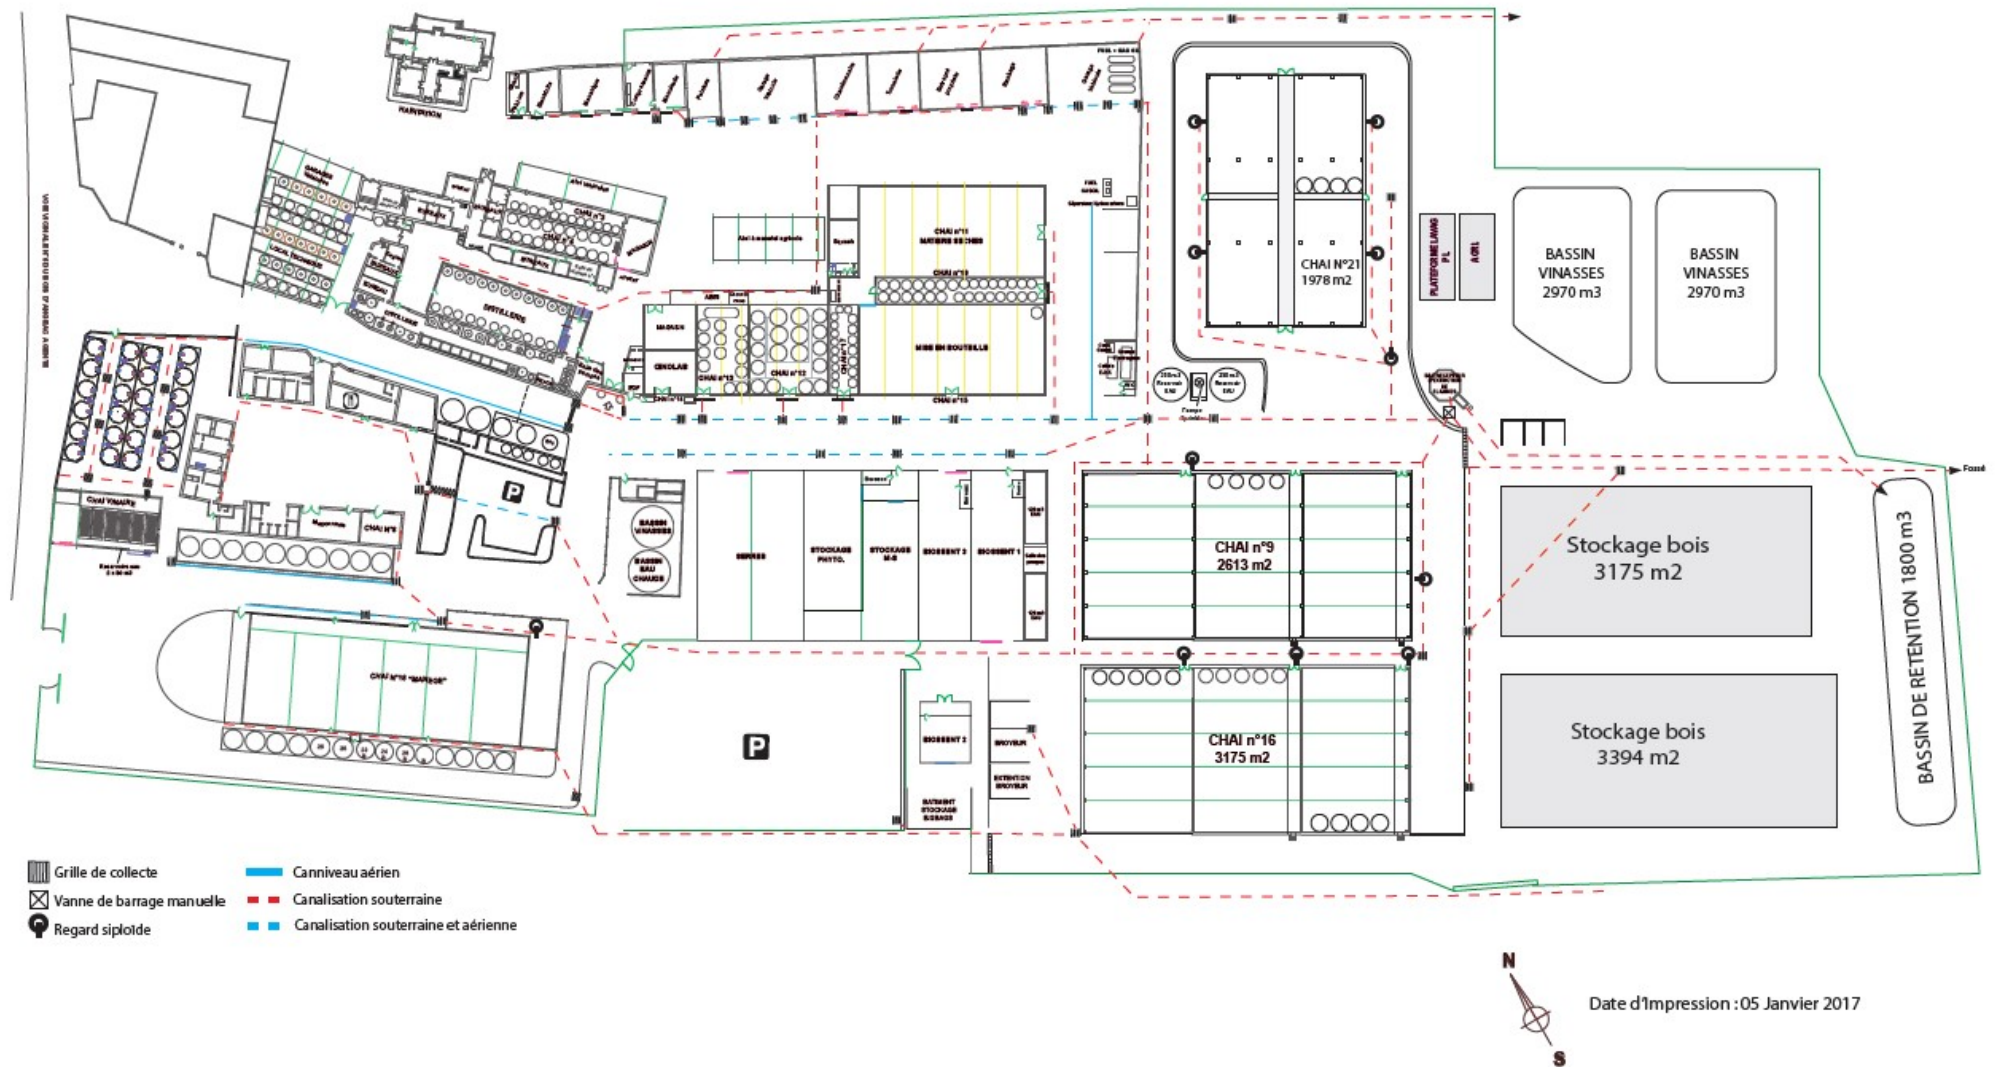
PLAN DE GESTION DES EAUX PLUVIALES – SITE EXISTANT
